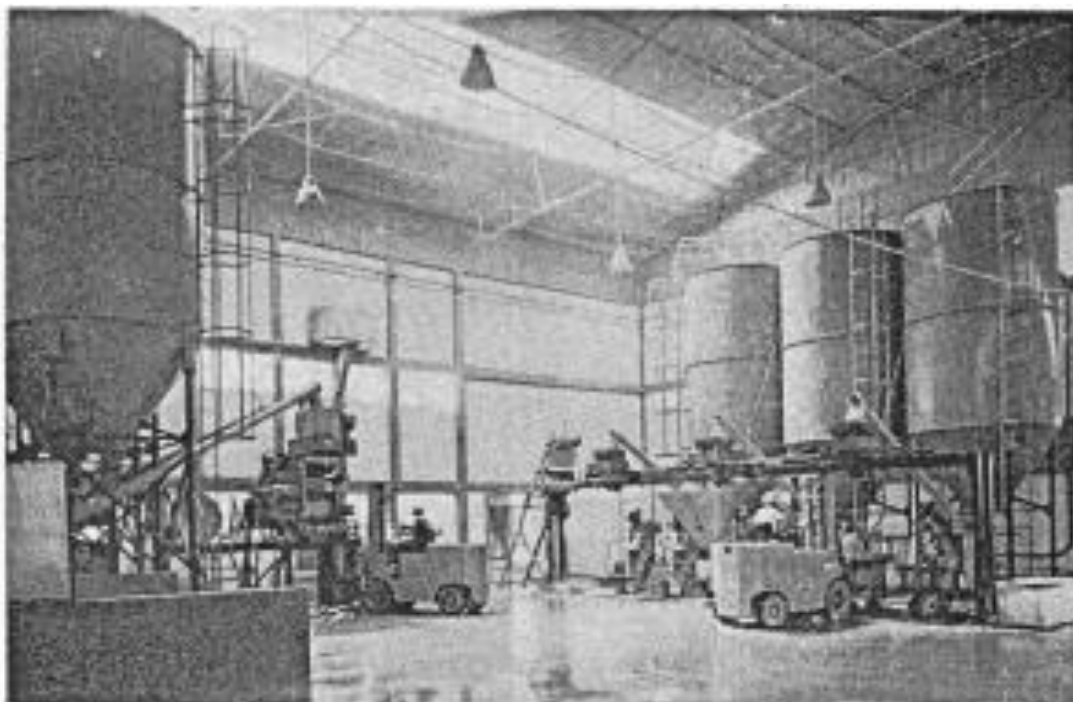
Central de betonagem e dosagem automática (Pinto, 1969).
